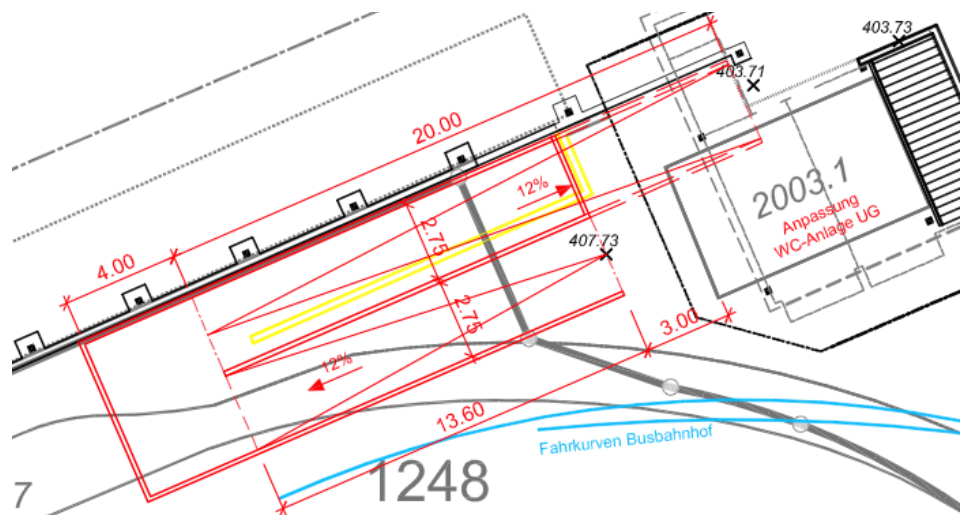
Variante 3 Rampe Personenunterführung, Standort Bahnhofgebäude West (Quelle: Ballmer + Partner, 2016)
